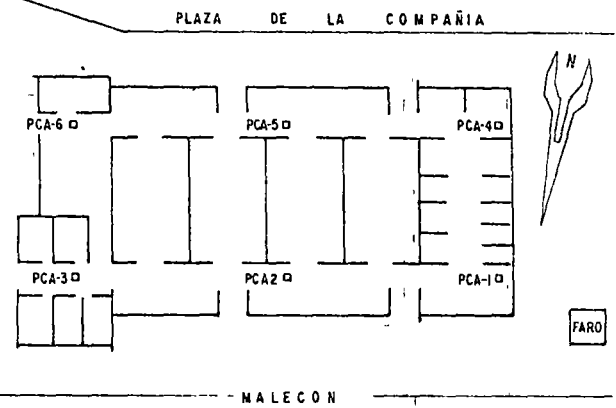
Planta del edificio y localización de pozos en un predio de Champotón.
